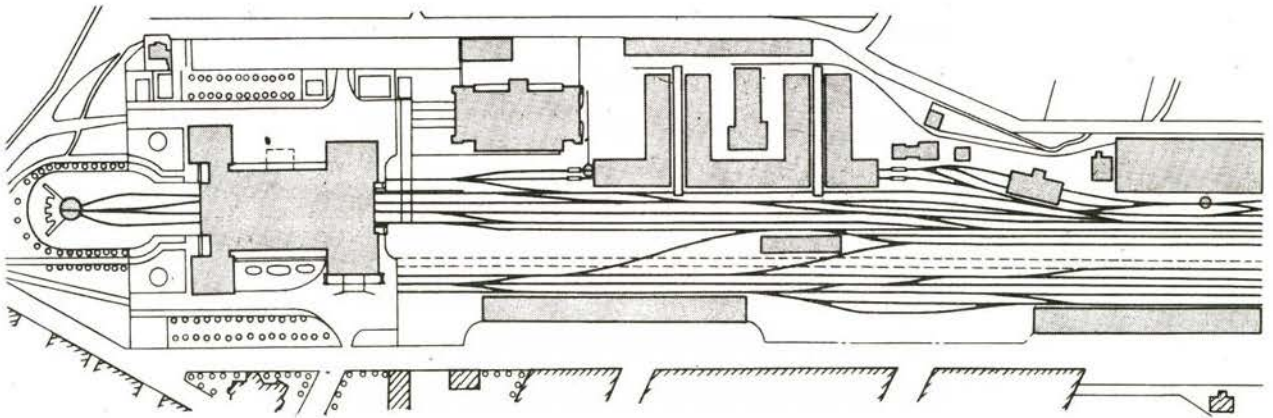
Lageplan des Bayrischen Bahnhofs um 1850; Entwurf Poetzsch
